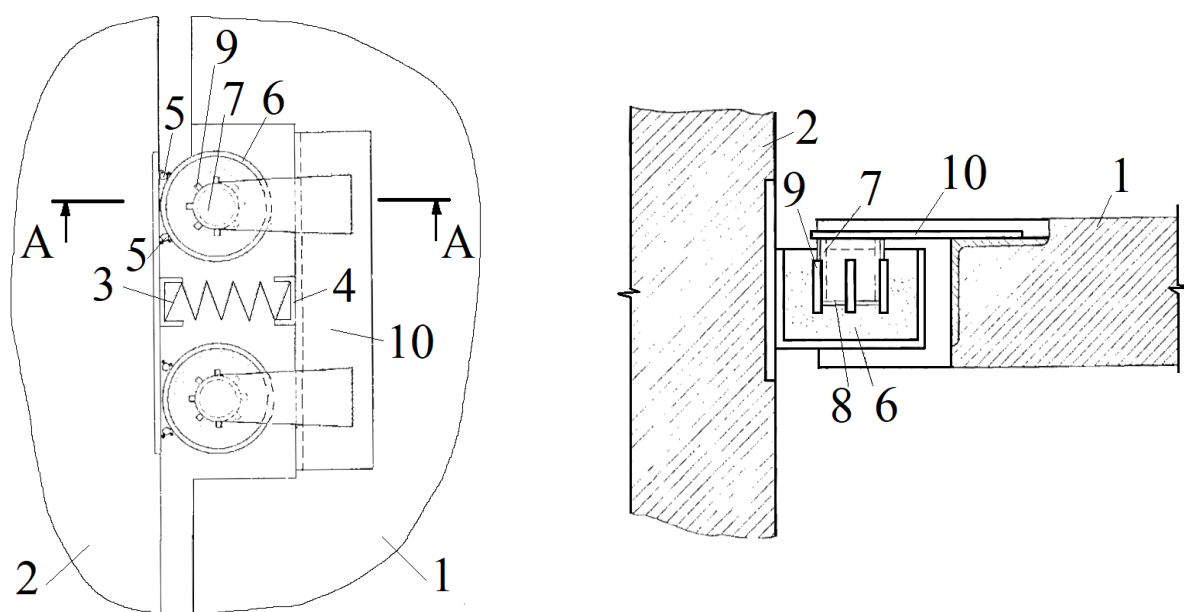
Узловое соединение междуэтажного перекрытия сейсмостойкого здания с внутренней жесткой шахтой: 1 – плита перекрытия; 2 – стена шахты; 3 – спиральная пружина; 4 – обрамляющие элементы; 5 – соединительные стержни; 6 – стакан с кварцевым песком; 7 – полый цилиндр; 8 – заглушка; 9 – вертикальные штыри; 10 – пластина
